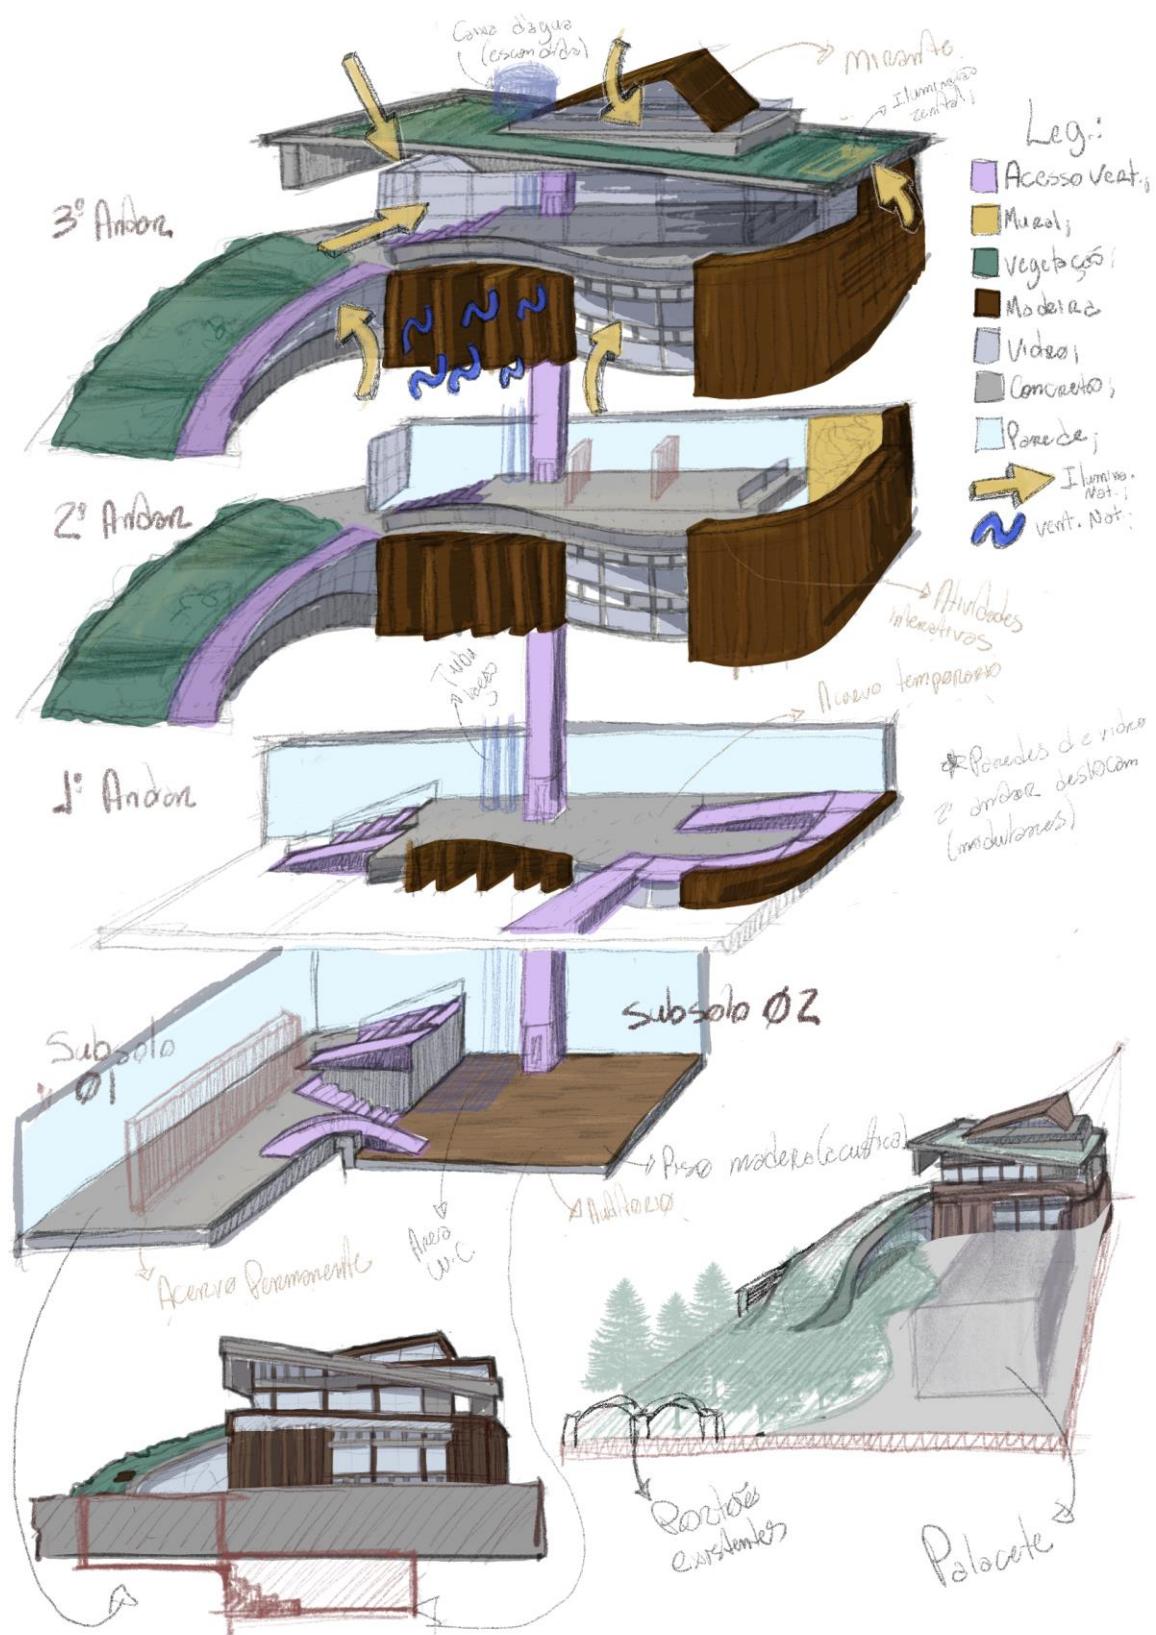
CROQUI ESQUEMATICO 1º PAVIMENTO.
